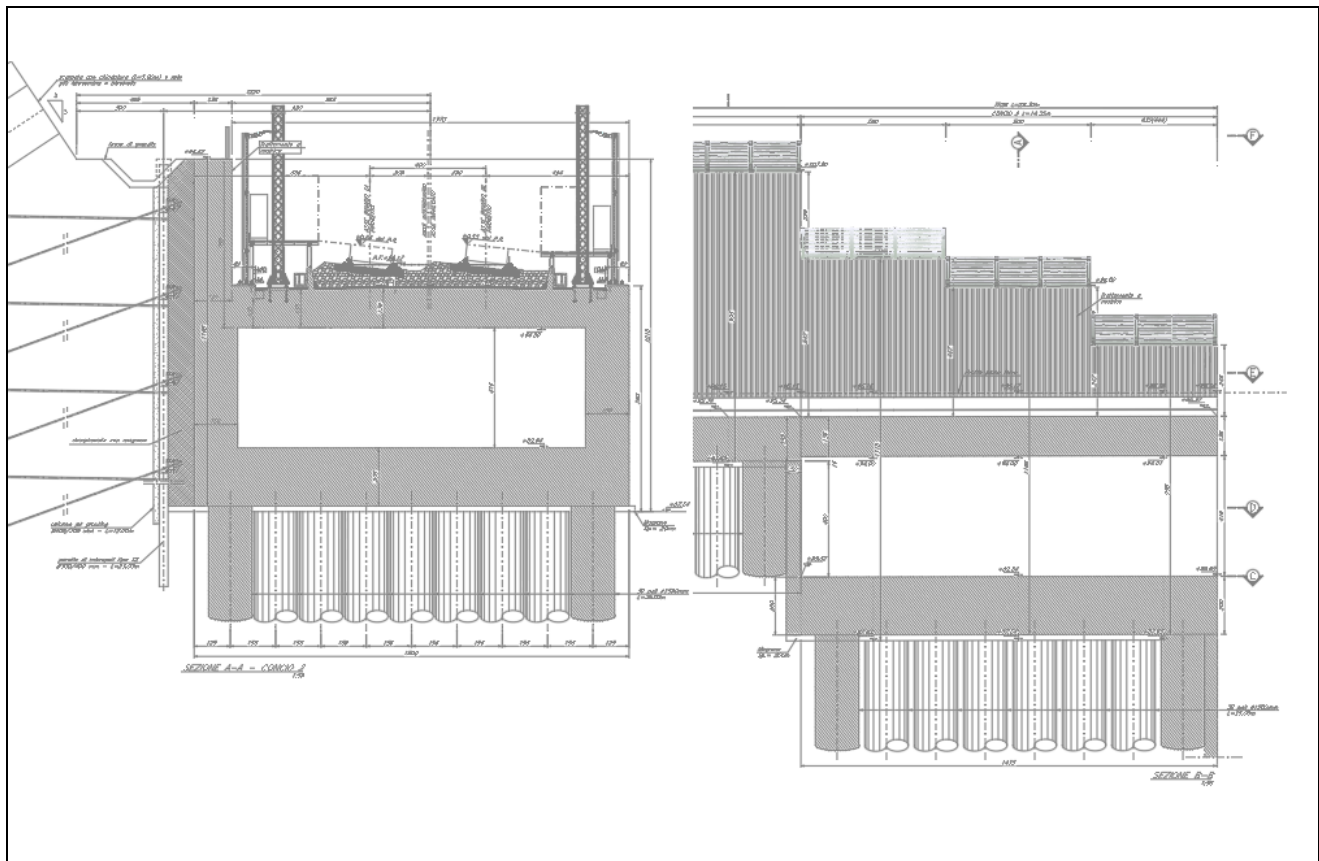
Sezione e prospetto Concio 2\_TR26
